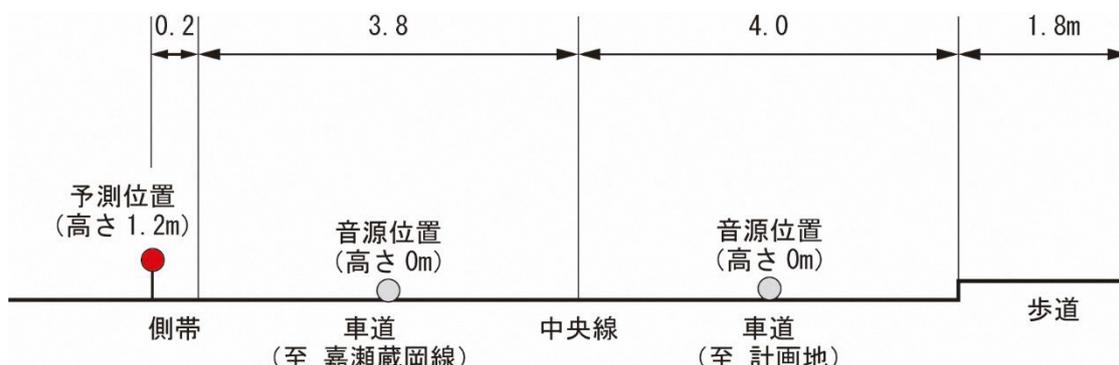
(1) 道路断面図 (No.1 : 南 6-79 号線沿道)
